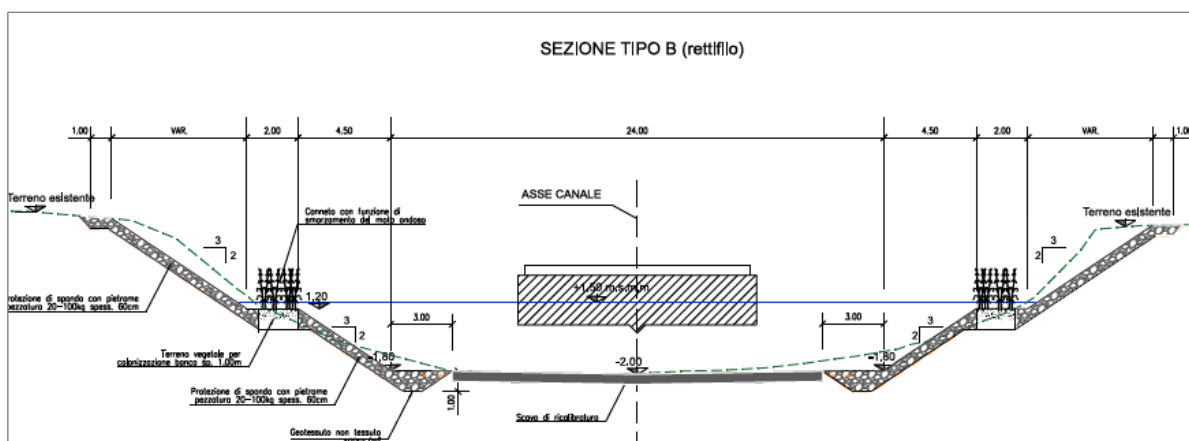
Sezione tipo B adottata nei tratti in rettilineo, con larghezza alla base di 24 m
